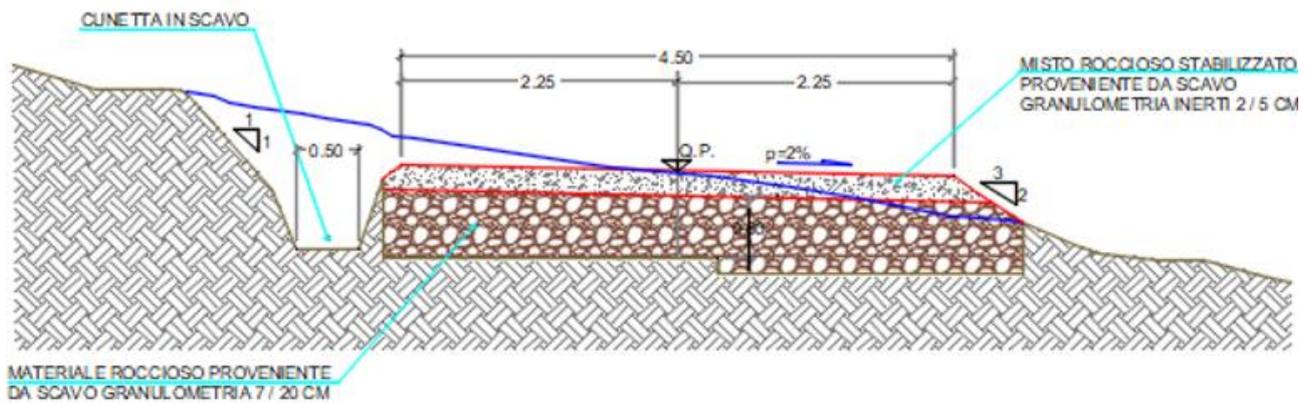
Sezione stradale "tipo" A MEZZA COSTA della viabilità di progetto (strade di accesso alle piazzole e relativo pacchetto stradale)
